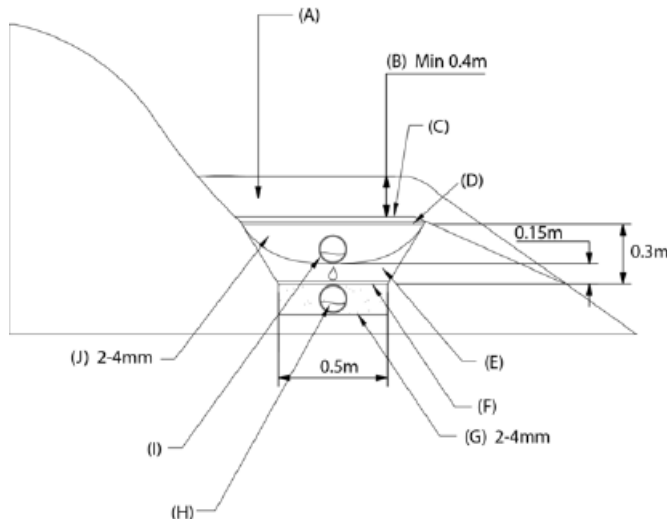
Situasjonsplan: Infiltrasjonsgrøft med drenering.
